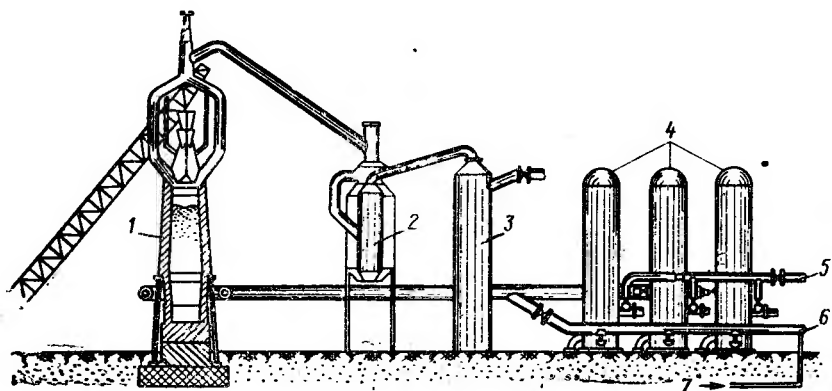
Схема листовых конструкций комплекса доменной печи и газоочистки
